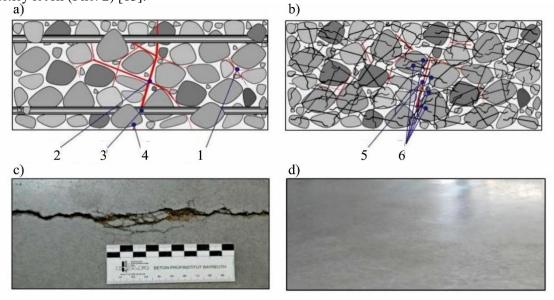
Схема появления трещин в железобетоне с армокаркасом (a,c) и сталефибробетоне (b,d): 1 — появление микротрещин в неармированной зоне; 2 — распространение и рост микротрещин, превращение в макротрещины; 3 —пересечение зоны армирования макротрещинами; 4 — выход трещины на поверхность; 5 — появление микротрещины; перекрытие микротрещины фибрами [14] Fig. 2. The pattern of cracks in reinforced concrete with reinforced frame (a,c) and steel fiber concrete (b,d): 1 — the appearance of microcracks in an unreinforced zone; 2 — the spread and growth of microcracks, turning into macrocracks; 3 — the intersection of the reinforcement zone with macrocracks; 4 — the exit of the crack to the surface; 5 — the appearance of microcracks; overlapping microcracks with fibers [14]
